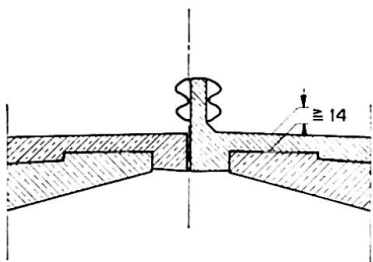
Leitschwelle auf dem Mittelstreifen — Stahlleitplanke an Beton-Leitschwelle.
